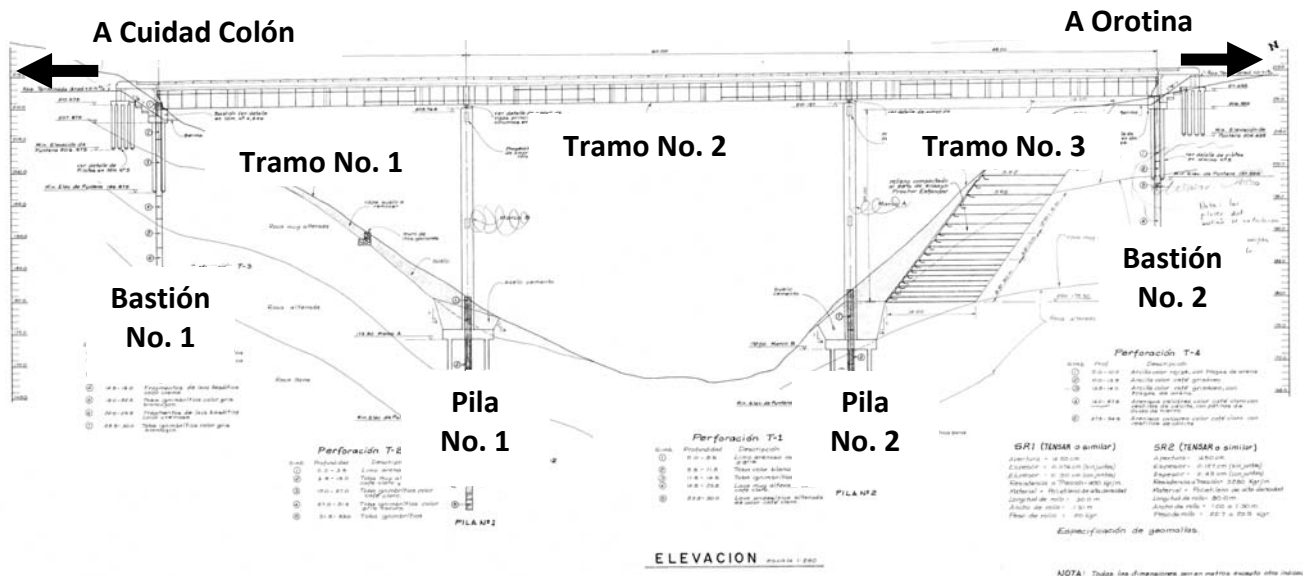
Vista en elevación norte del puente incluida en los planos estructurales.
